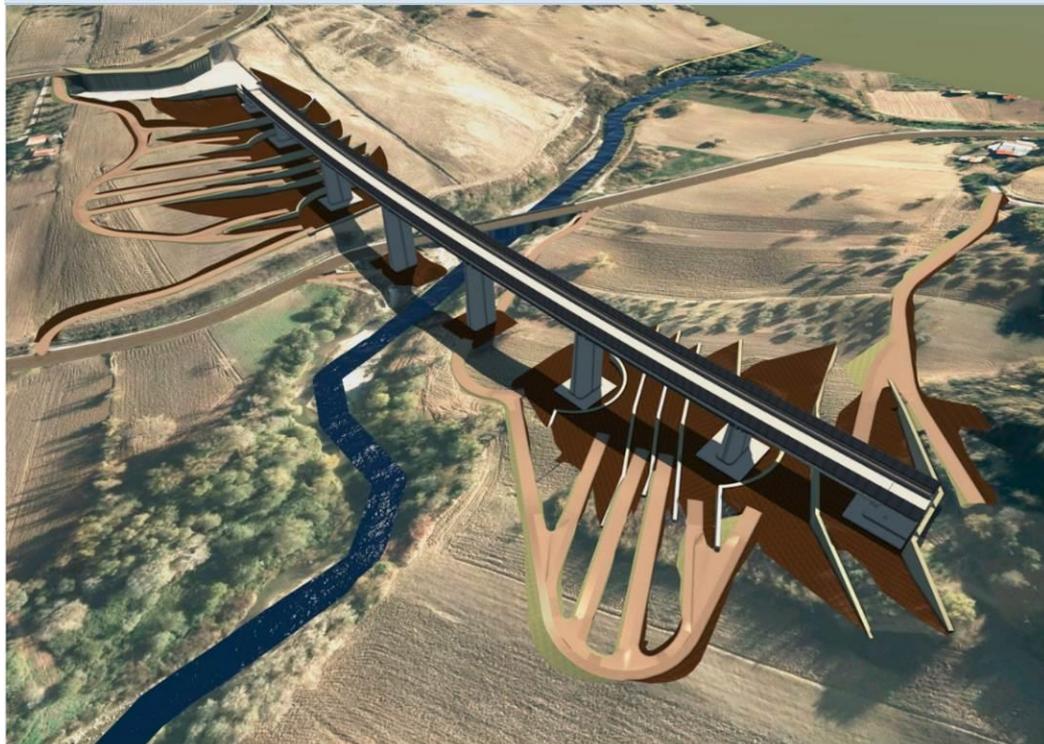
Viadotto VI03: Inserimento del modello BIM tridimensionale nel modello digitale del terreno e studio delle modalità di accesso alle aree di lavoro per la realizzazione delle opere di fondazione delle pile e delle spalle.
